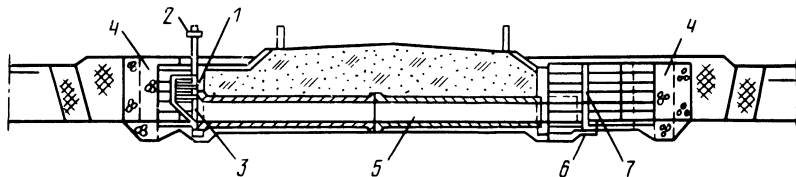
Трубчатый шлюз-регулятор с коробчатым затвором:
